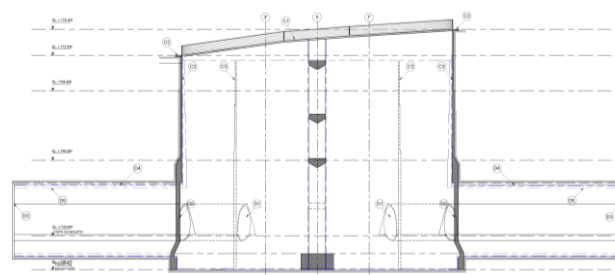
Vista esquemática de la fase 1 del pórtico en la etapa 3 del proceso constructivo. Estructura del pórtico sin losa de fondo (solo la viga inferior) y con el revestimiento primario ejecutado (sin revestimiento secundario).
